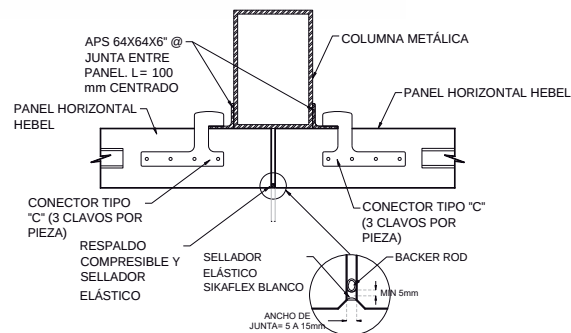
Anclaje de panel de concreto celular a columna metálica. Elaboración propia.
